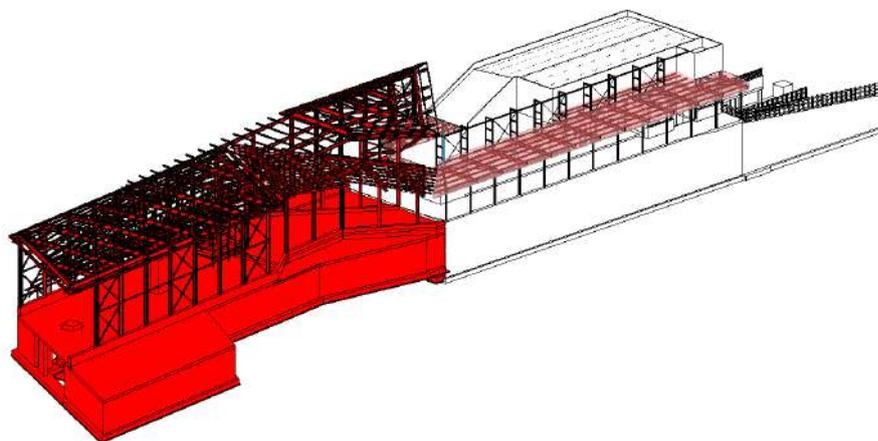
STAZIONE DI VALLE – STRUTTURE NUOVW
